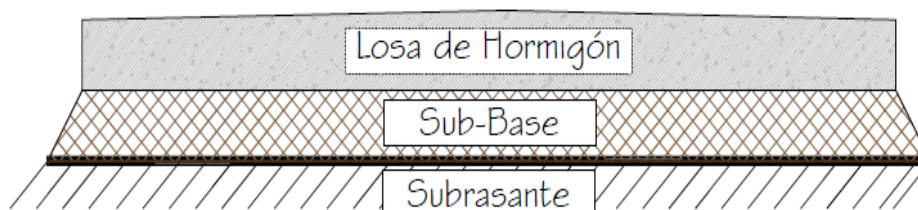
Sección transversal del pavimento rígido. Compuesta por losas de concreto que requiere un mantenimiento mínimo, principalmente en las juntas de losa, la distribución de las deformaciones se da a lo largo de la capa de losa de concreto; Adaptado de “Evaluación superficial del algunas calles de Loja”, por Armijos, C., R., 2009, p. 5, por Universidad particular de Loja.
